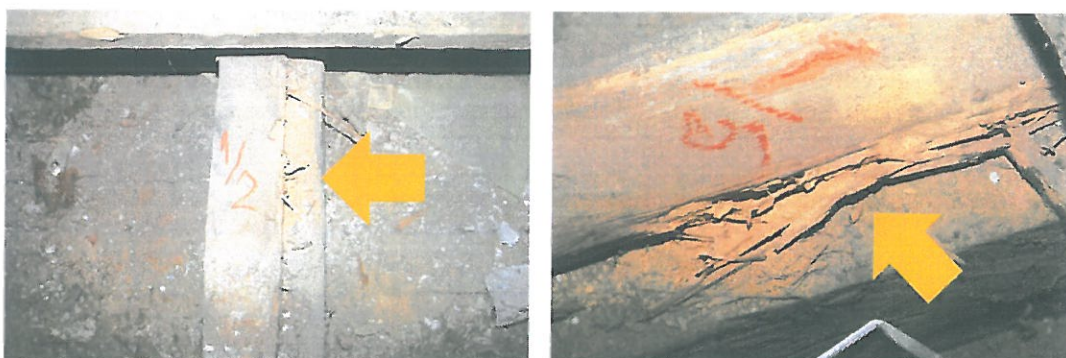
, 4 Miejsce odkrywki na łączeniu stropu drewnianego i żelbetowego.
